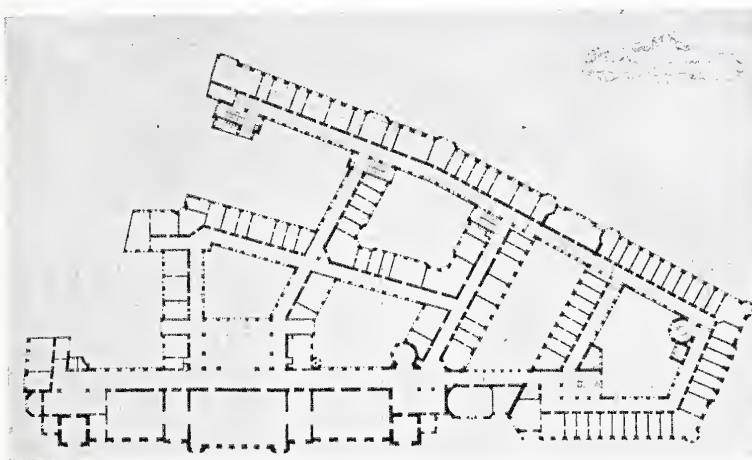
Grundriß vom II. Obergeschoß (Hauptgeschoß).
